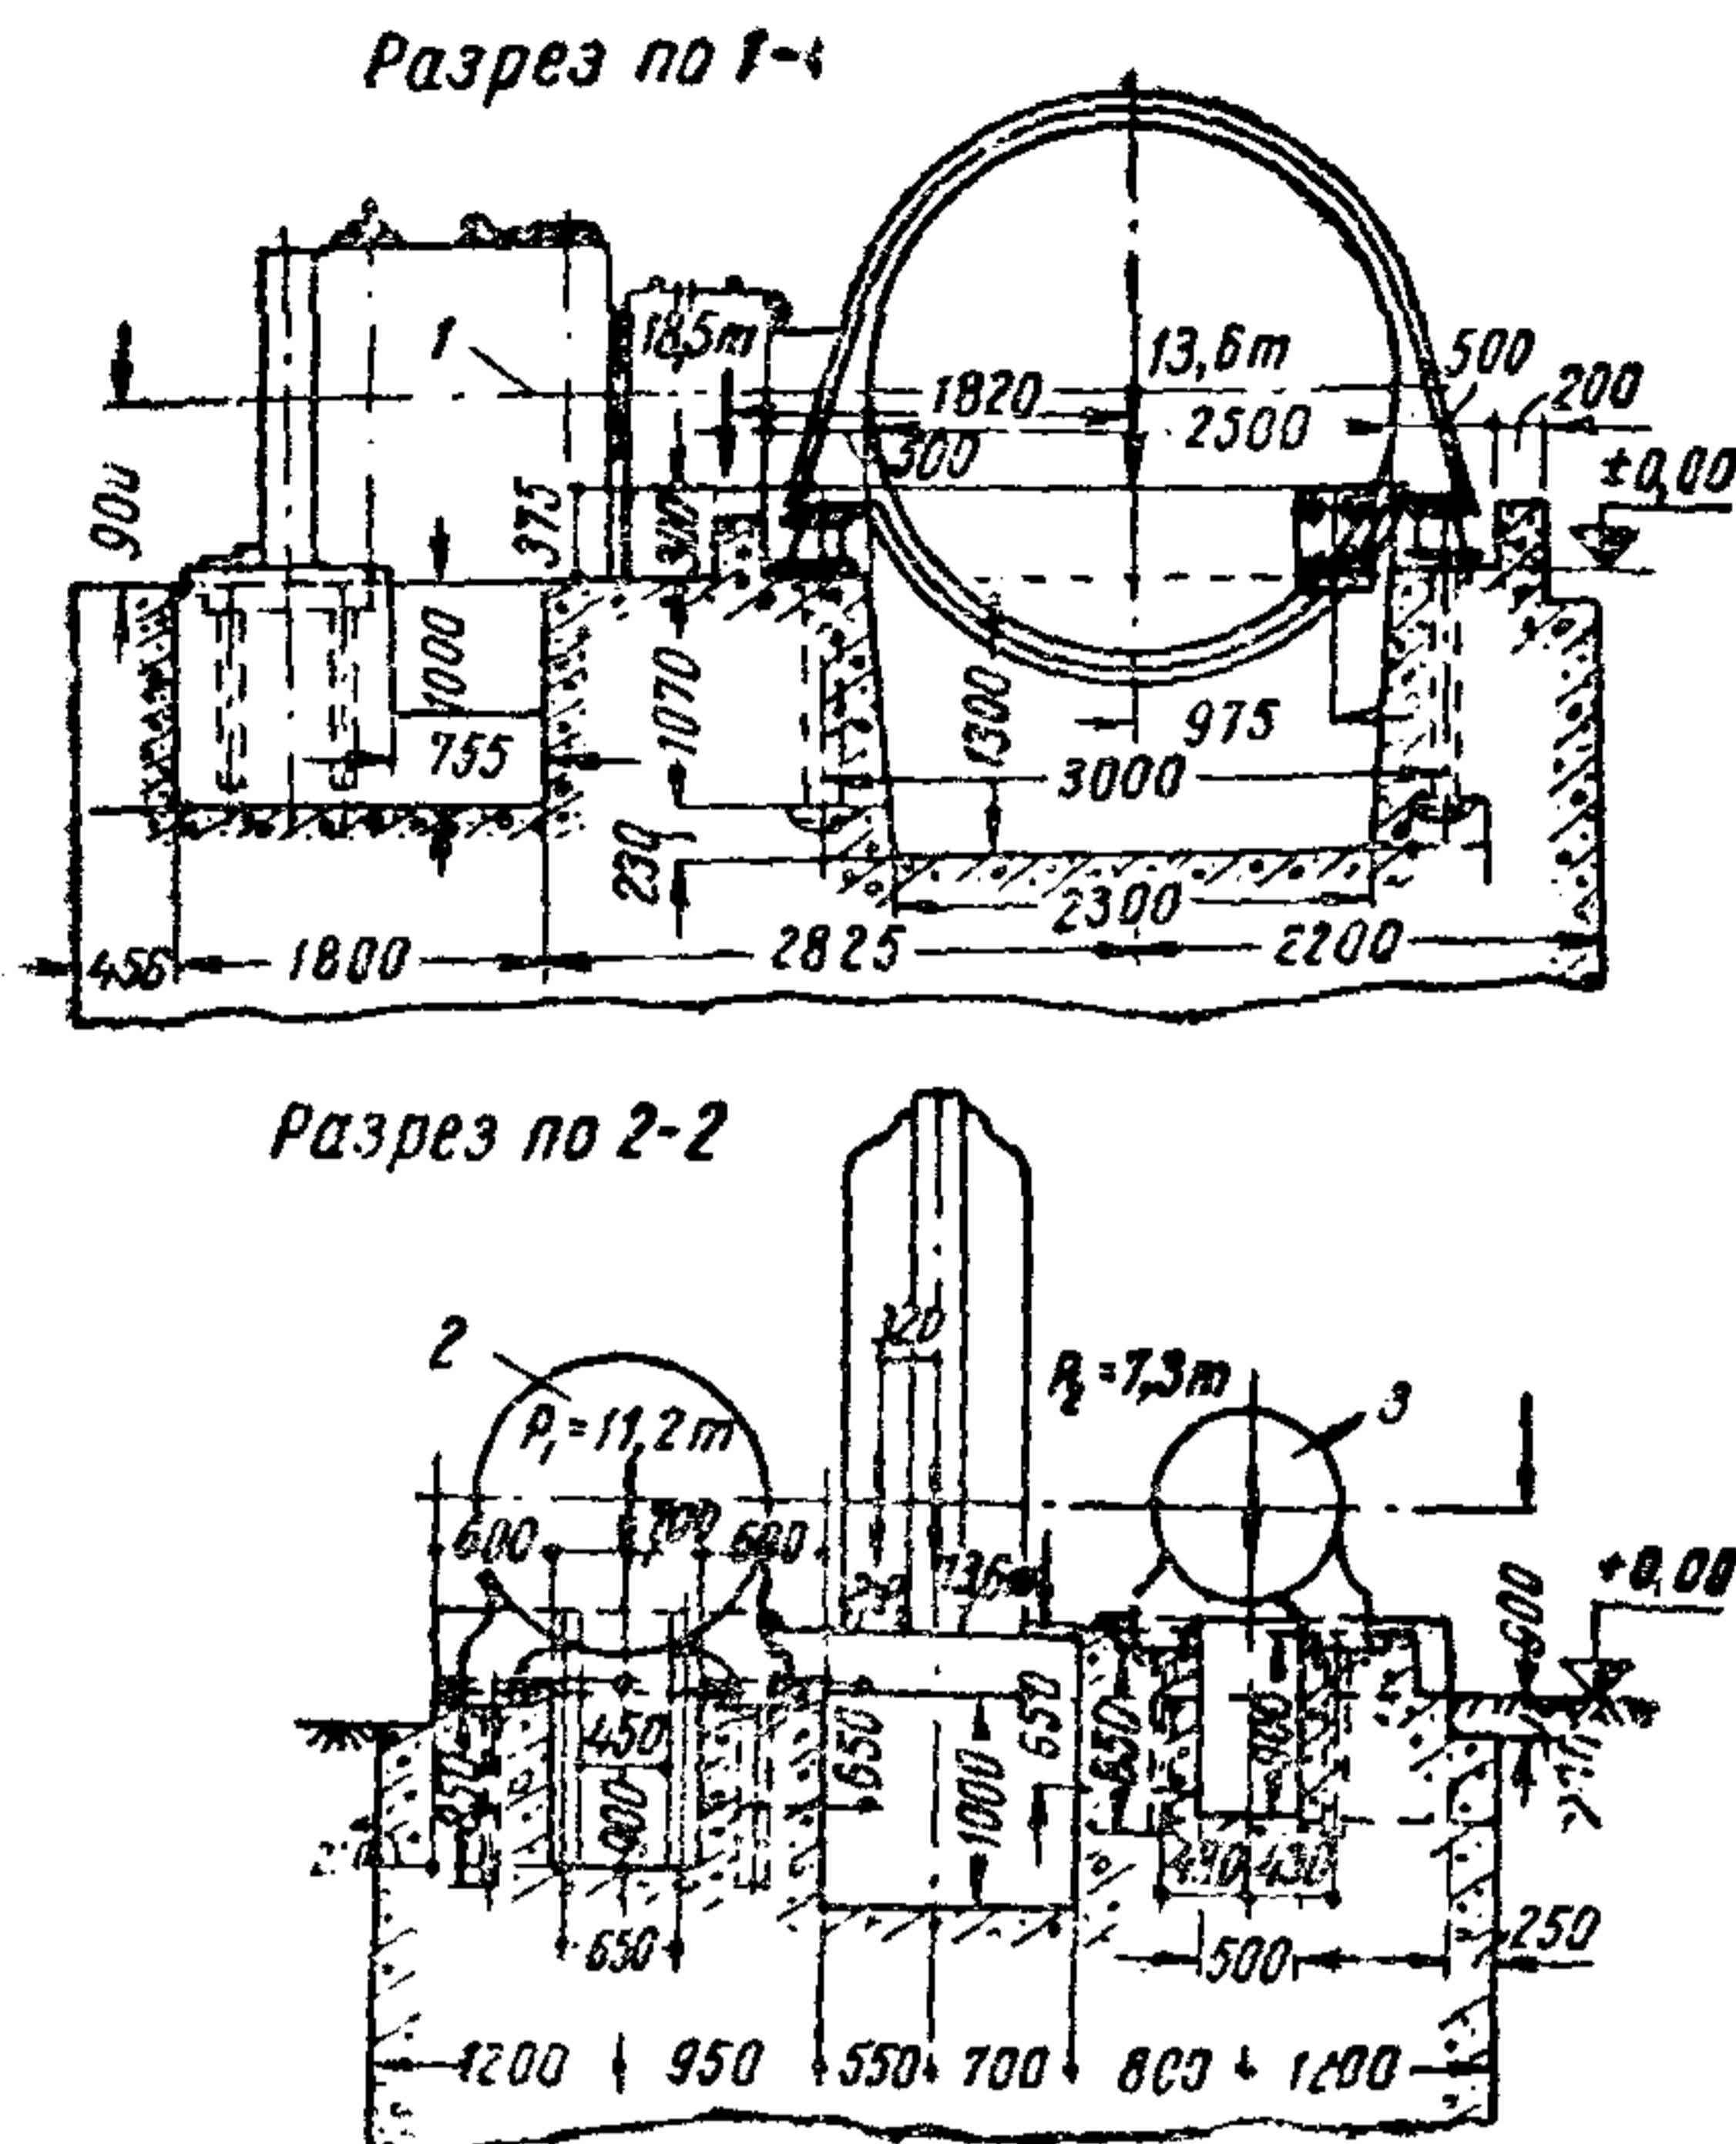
Чертежи габарита фундамента под поршневой двухцилиндровый горизонтальный компрессор 2ВГ (разрезы—см. рис. 1). Расположение цилиндров компрессора и схемы распределения статических нагрузок
